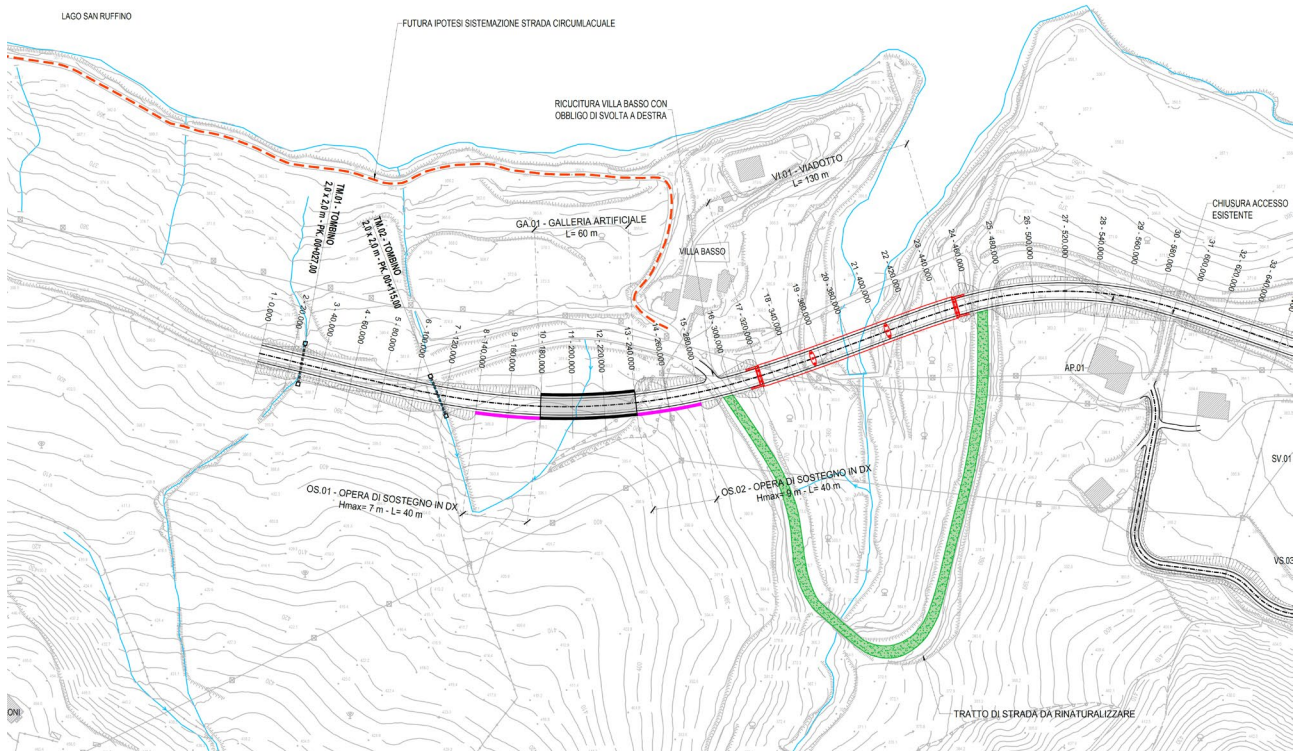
Planimetria del primo tratto con la galleria artificiale e il viadotto che attraversa l'insenatura del lago
